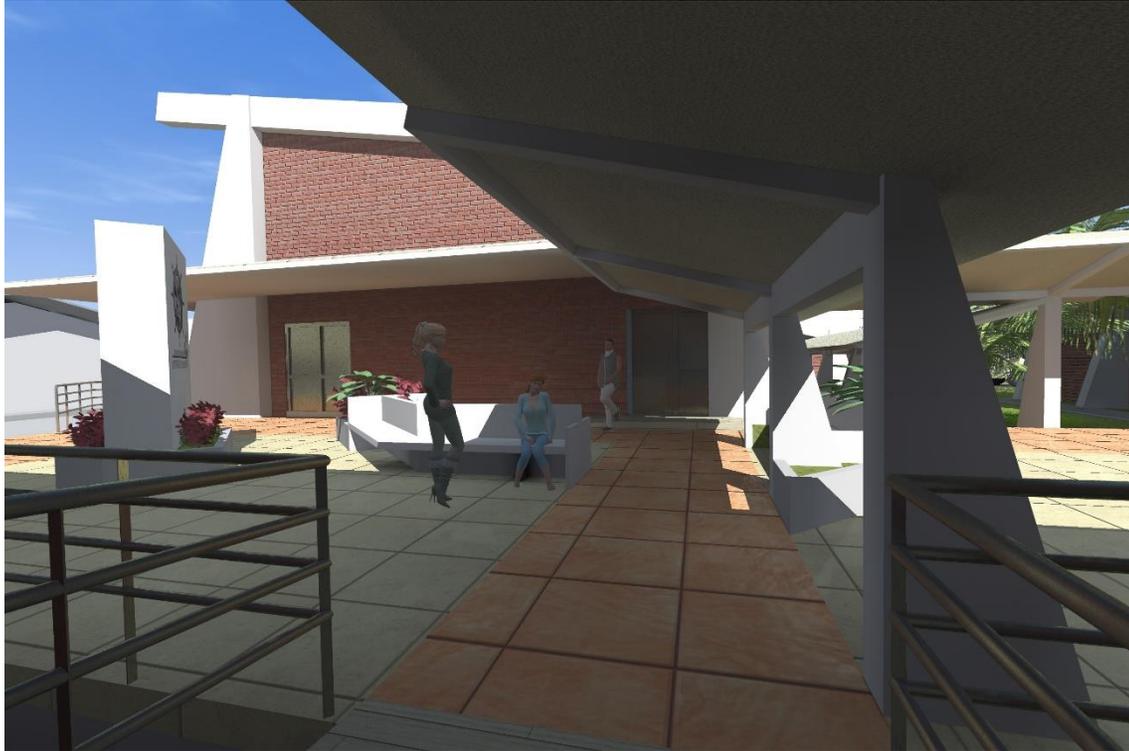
Plaza, vista desde la biblioteca hacia el auditorio.
